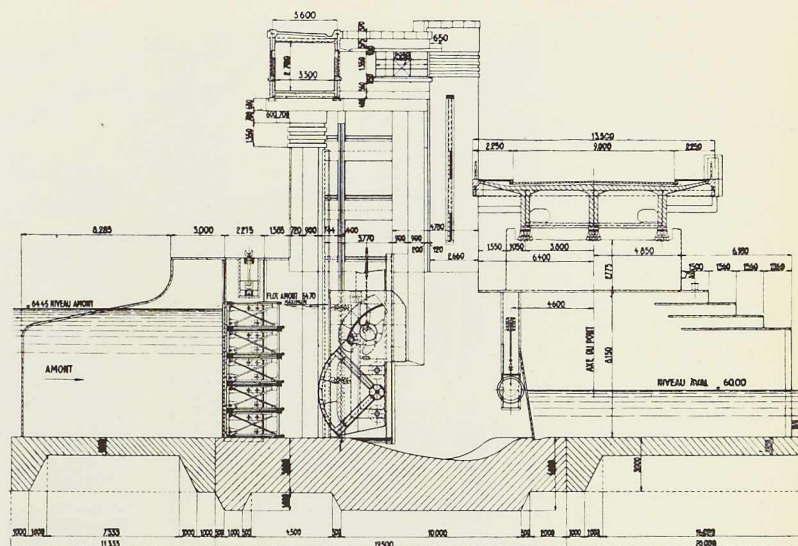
Coupe axiale d'un pertuis faisant bien apparaître les dispositions des vanne principale, hausse, pont-route, passerelle de service et bouchures de secours.
